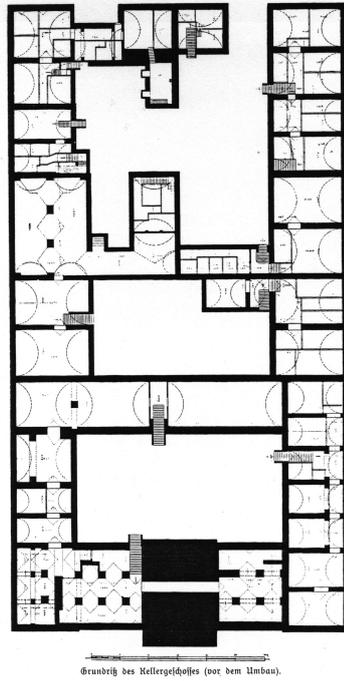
Grundriß des Kellergeschoßes vor dem Umbau
